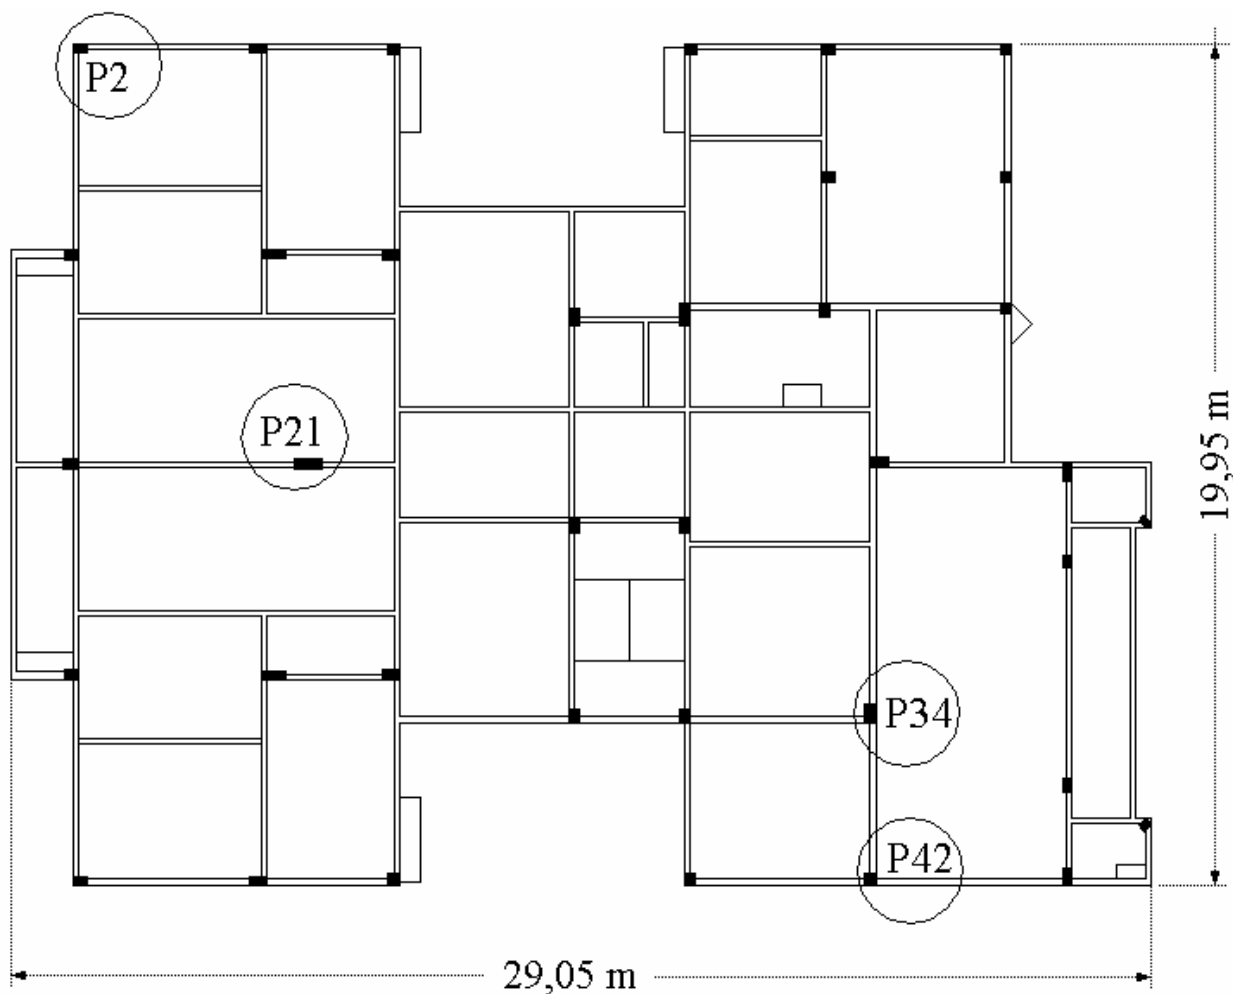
Planta de formas dos pavimentos tipo da estrutura usada no estudo
